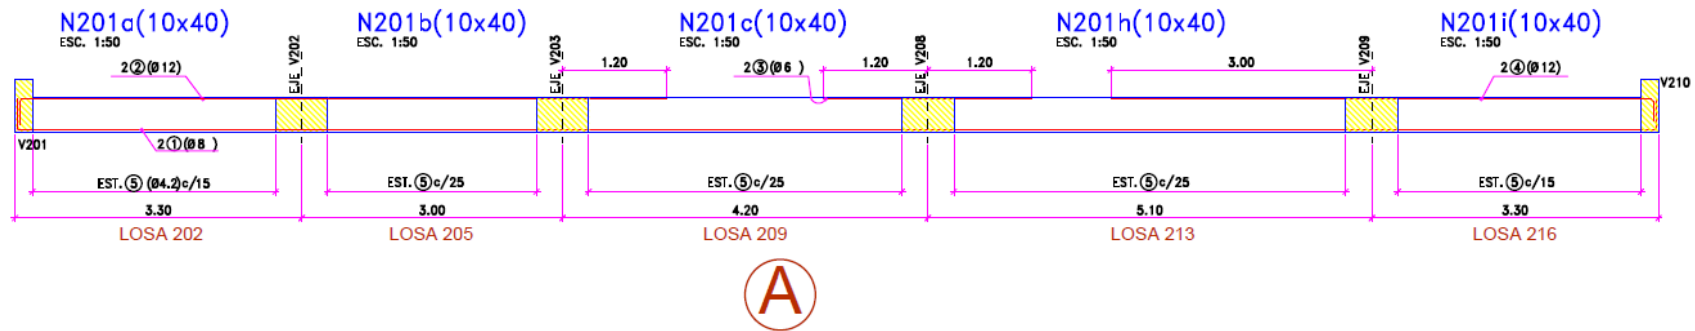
Corte longitudinal del nervio A Sobre 2º PISO
